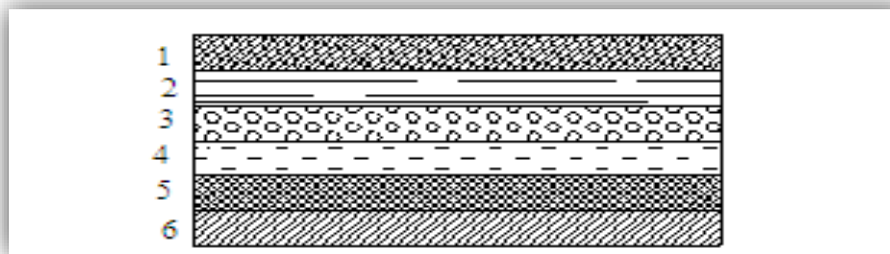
Coupe verticale du plancher terrasse à dalle pleine .
